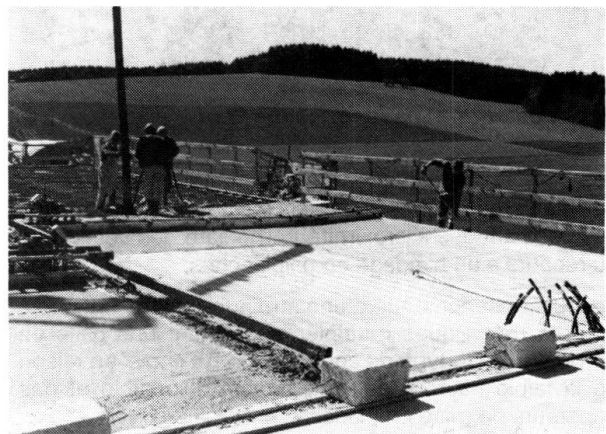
Das Abziehen des Betons mit Tremix Flächenfertiger
